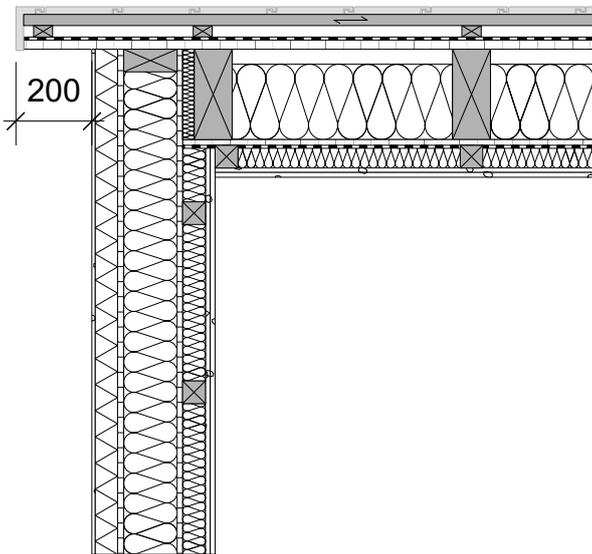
Anschluss Steildach DA2 - Außenwand WA1-3
